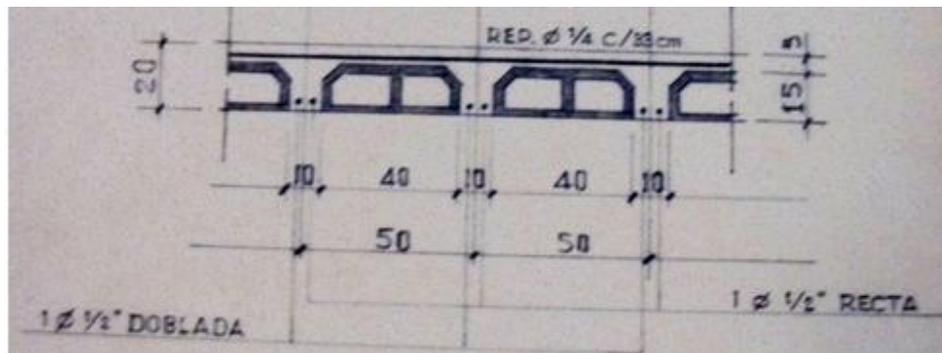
Sección Transversal del Losas del Nivel Techo.
